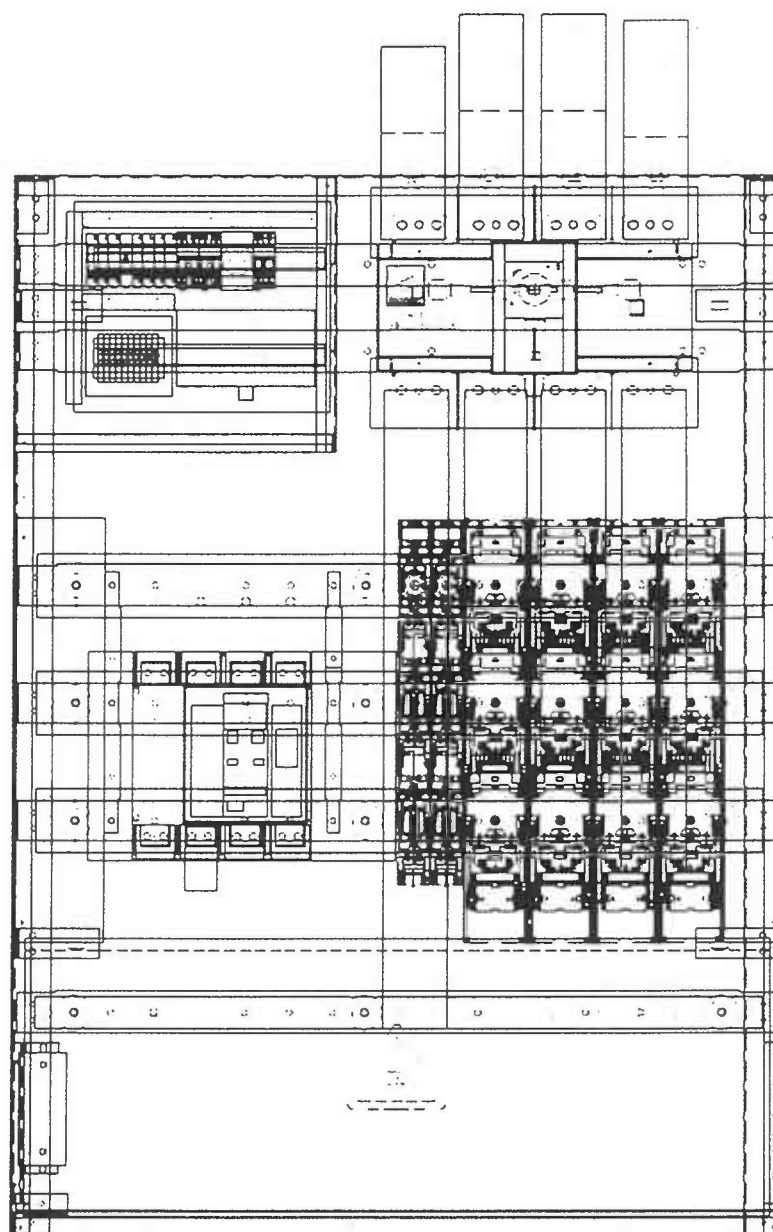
C - Disposição dos equipamentos no quadro R1000 com disjuntor
